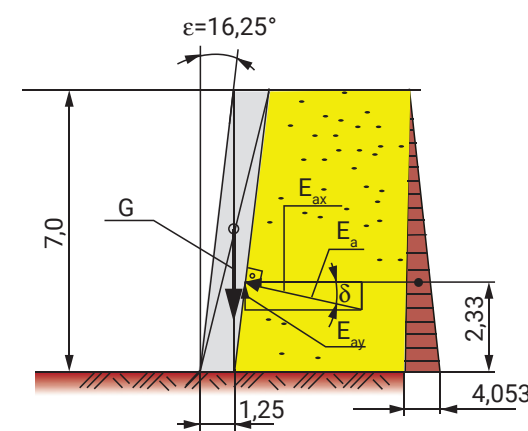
Расчетная схема подпорной стены устоя моста для расчета устойчивости положения на плоский сдвиг
